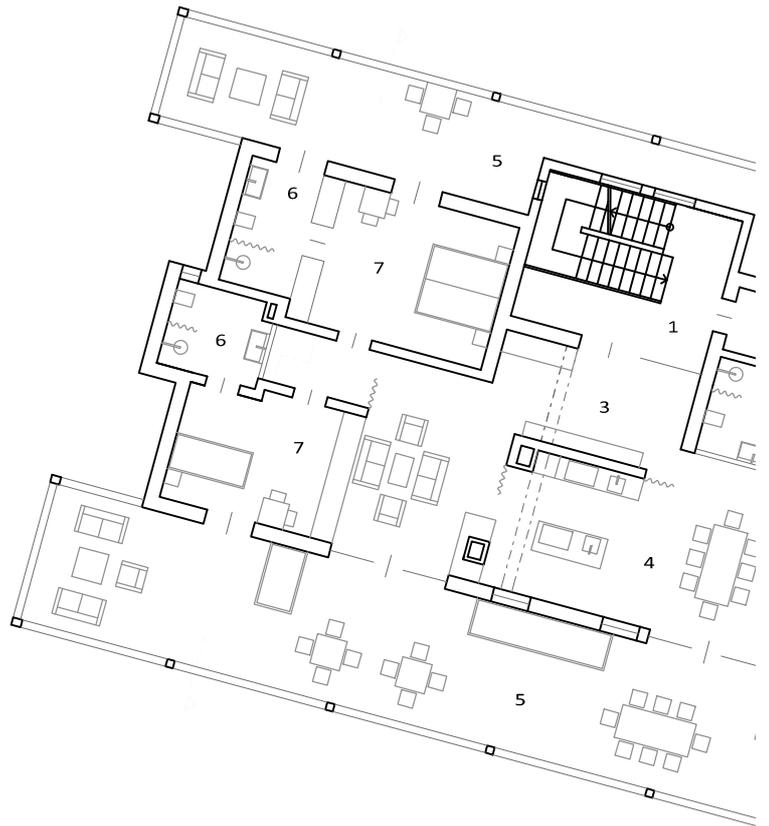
Grundriss Erdgeschoss 1:200
